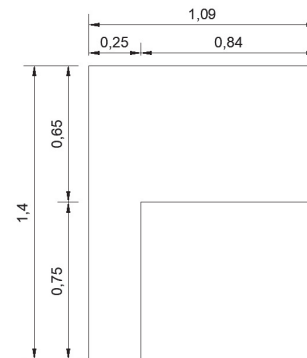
Section de la poutre de rive (2^{ème} phase)
